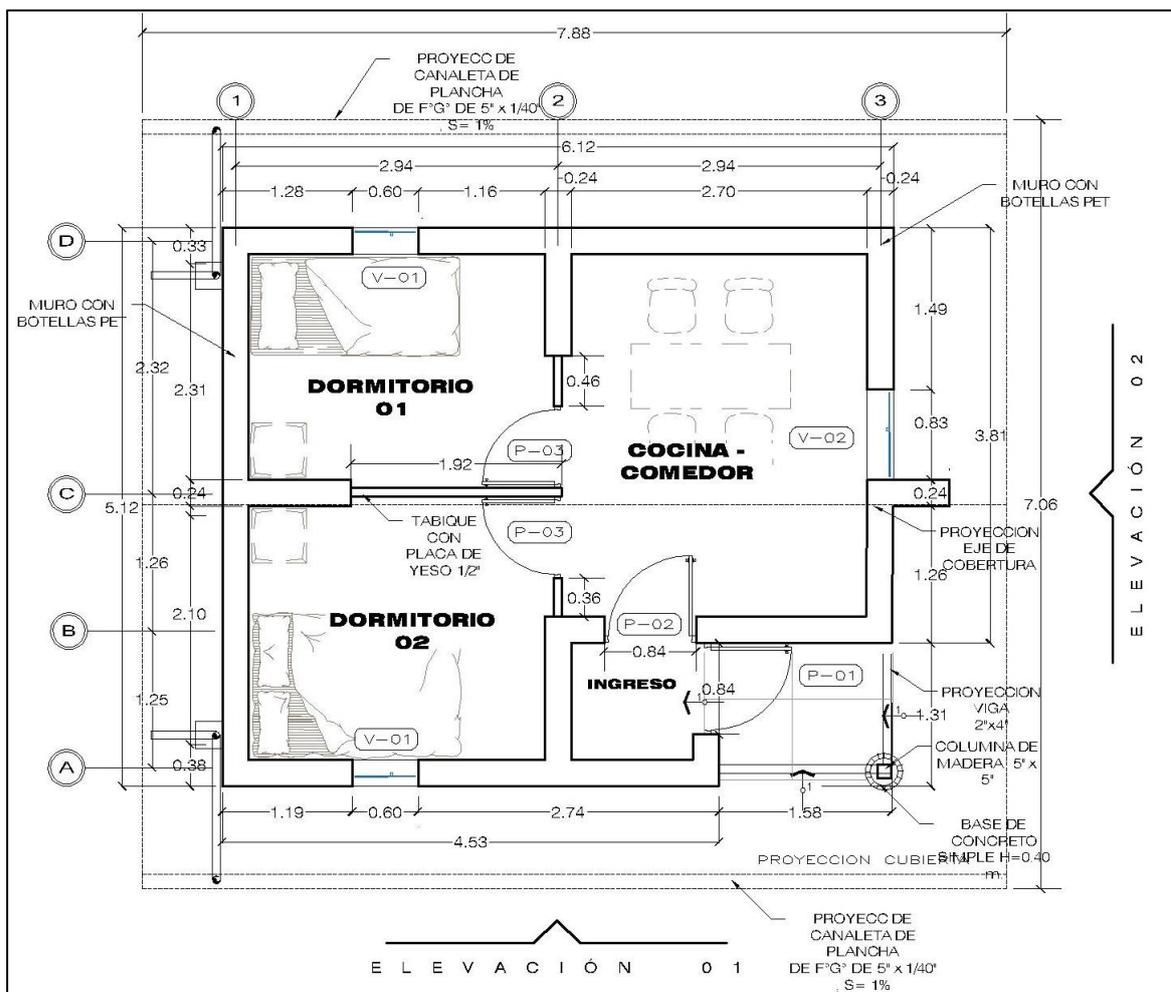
Diseño de una vivienda con muros de botella PET, vista en planta
